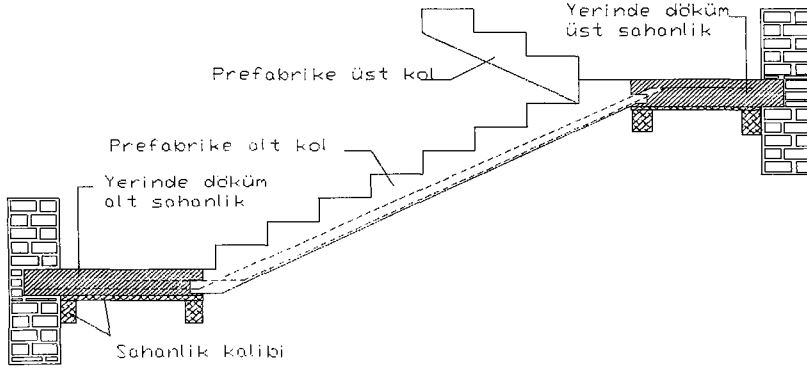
'de yapılan çözüm kıvrımlı plak etkisinin oluşturulması için önerilebilecek bir metoddur. Sahanlık plağında oluşturulan bir bölgede sahanlık demirlerinin filizleri ile prefabrike kol plağının filizleri birleştirilerek arada kalan kısım yerinde betonlanır. Bu işlem birleşimin monolitik olmasını sağlar.
